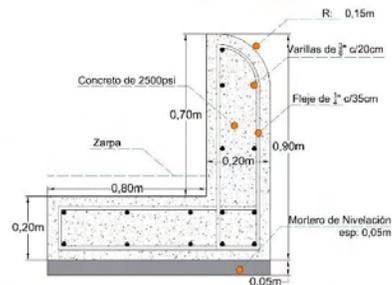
Detalle Sardinel Tipo con Zarpa. Fuente: Elaboración Propia
